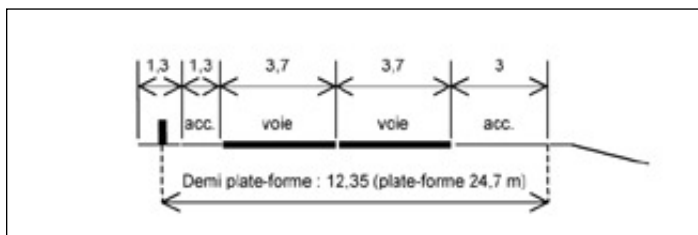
Route nationale à chaussées séparées par un dispositif de retenue central: profil en travers
